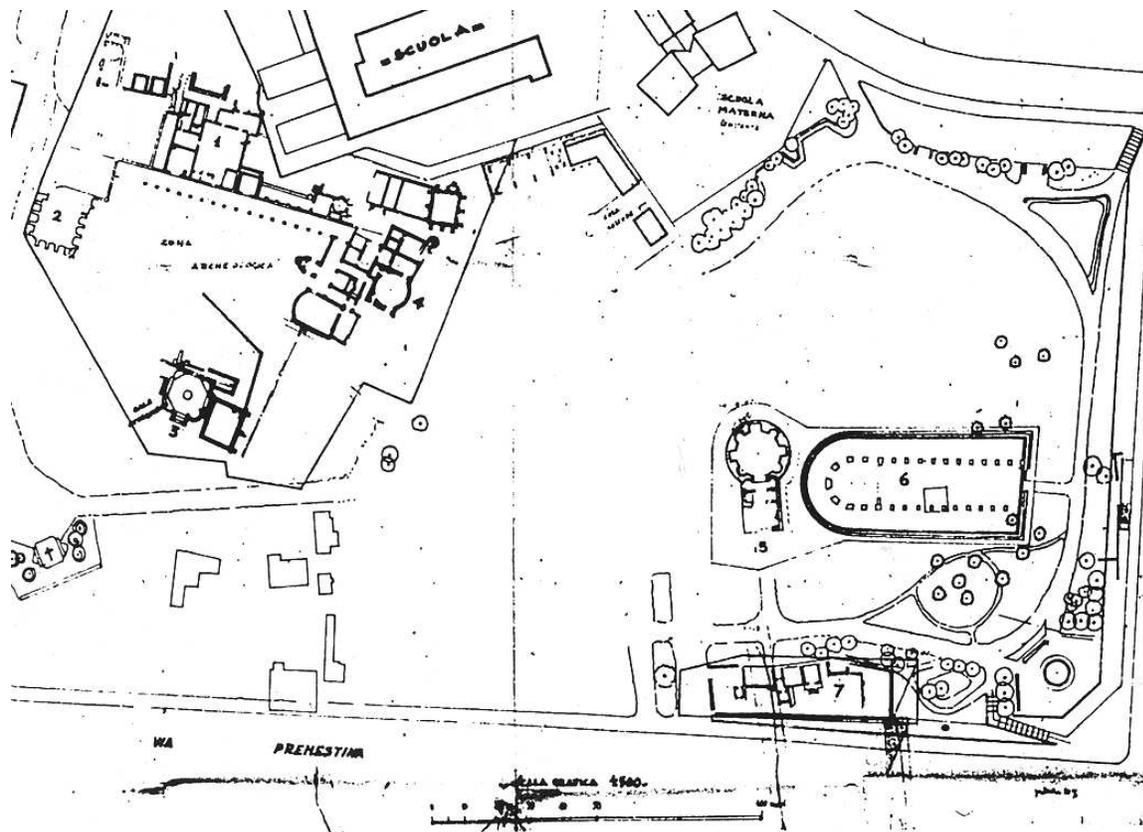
Planimetría del parque de Villa Gordiani. Archivo fotografico X Rip. AA.BB.AA. Comune di Roma.
